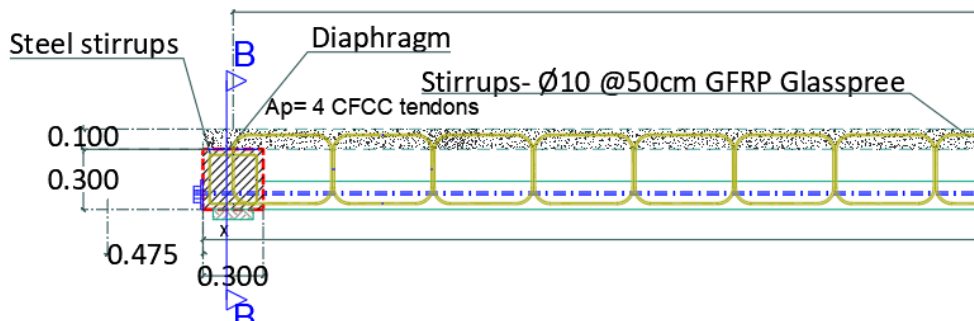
Sección longitudinal de la primera geometría proyectada
